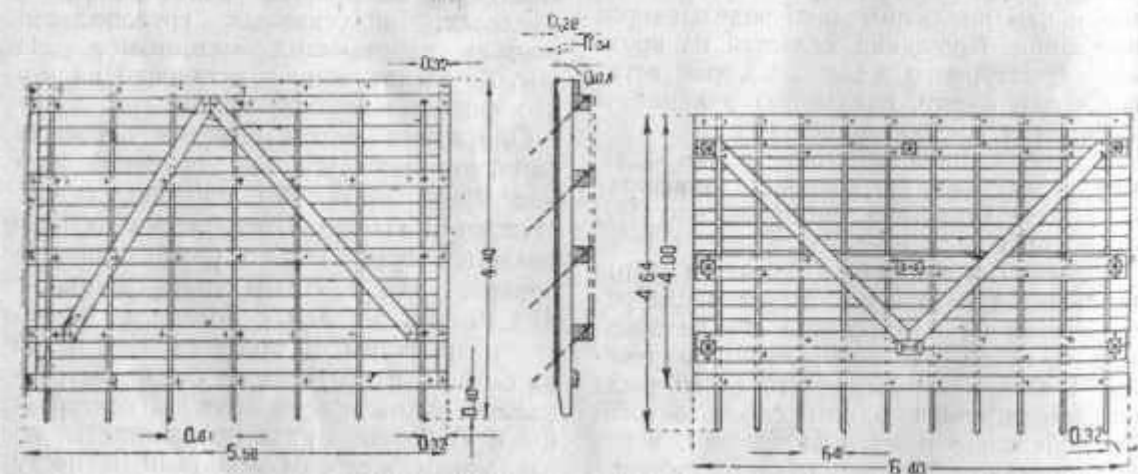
Типовая щитовая опалубка для бетонных работ.
